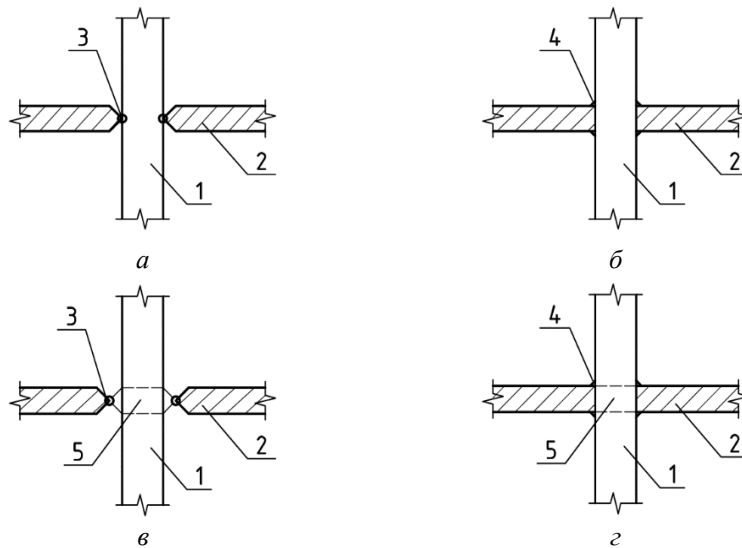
Схеми конструктивних форм з'єднання збірних та монолітних плит перекриття з трубобетонною колоною: 1 – трубобетонна колона; 2 – плита перекриття; 3 – шарнірне з'єднання плити перекриття з трубобетонною колоною; 4 – жорстке з'єднання плити перекриття з трубобетонною колоною; 5 – елемент, що перетинає бетонне ядро трубобетонної колони
